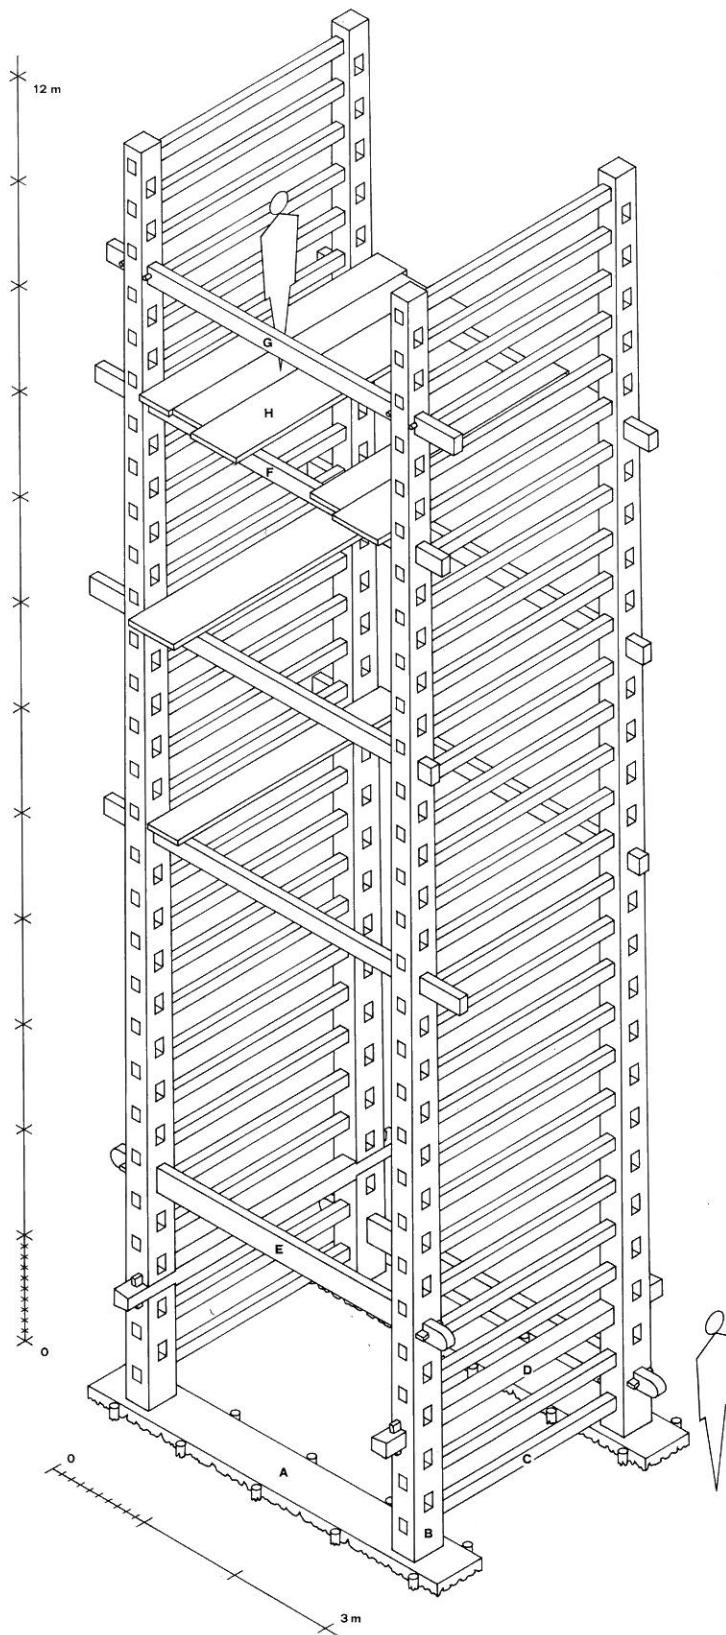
Rekonstruktion des mutmasslichen Gerüstturmes.
